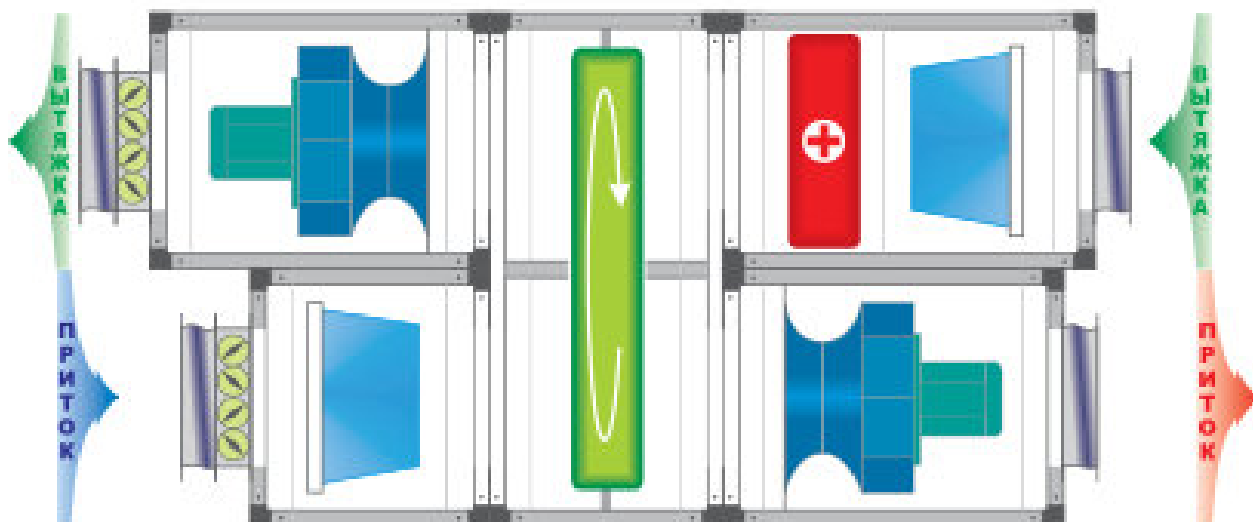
Схема припливно-витяжної установки з роторним регенератором
